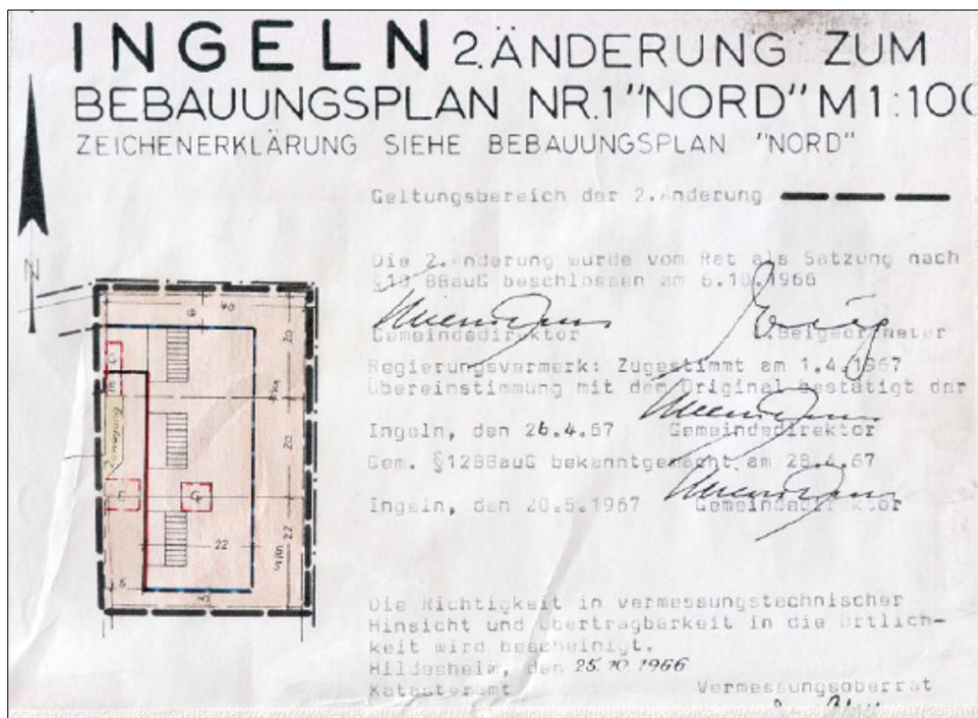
Auszug Bebauungsplan Nr. 301 „Nord“, 2. Änderung (ohne Maßstab)
